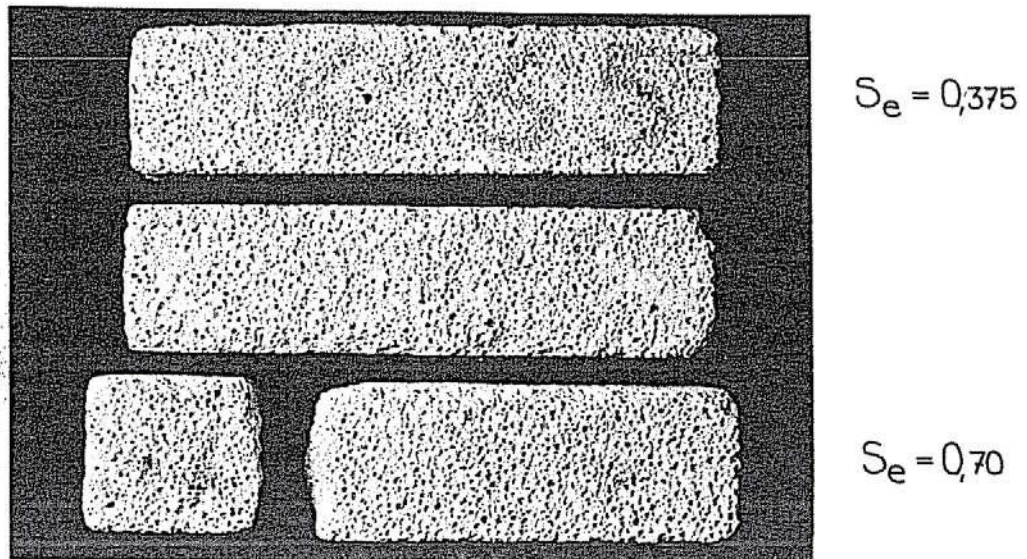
Material nr 11. Gasbetong typ 4. Oskadade och skadade provkroppar. Cellular concrete type 4. Intact and damaged specimens.
